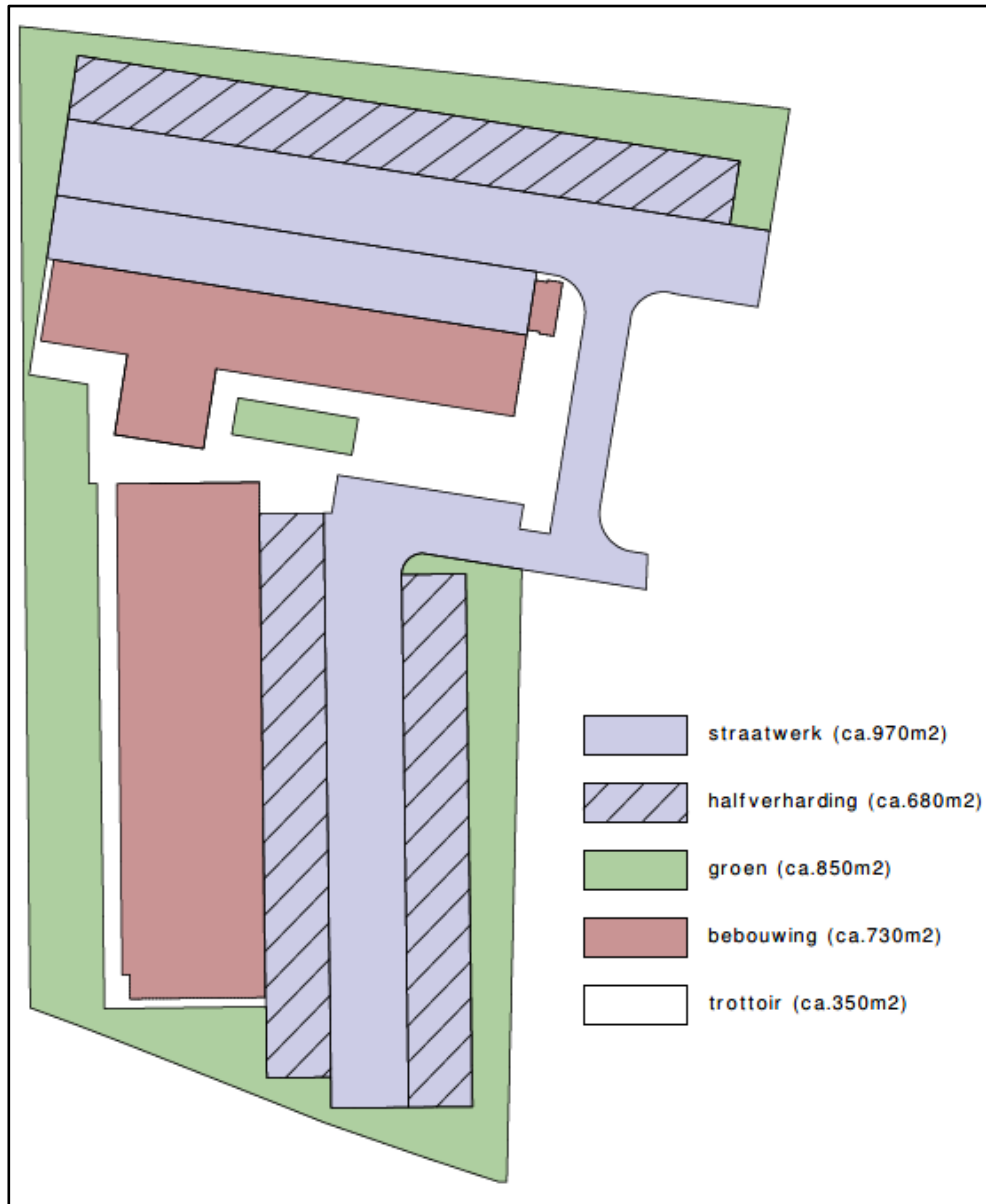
Structuurontwerp woningbouwontwikkeling (bron: Woudstra Architecten).
